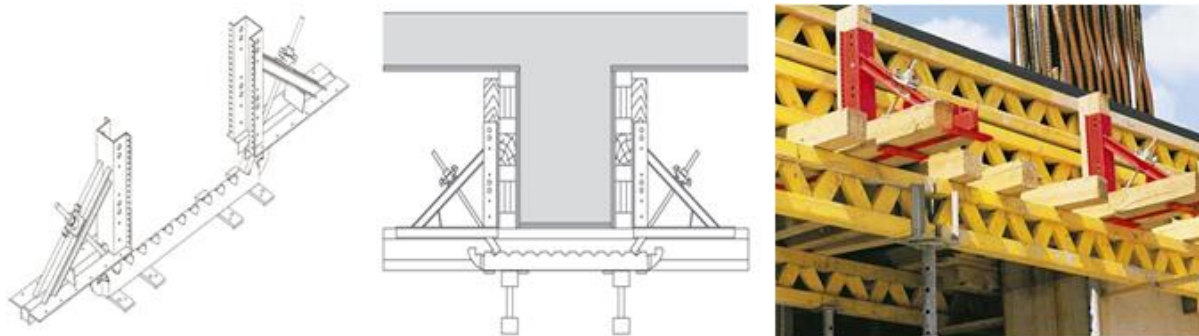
Consola para Viga UZ 40 e Calha Perfurada, sistema sem ancoragens e ligação rígida (PERI 2002).
